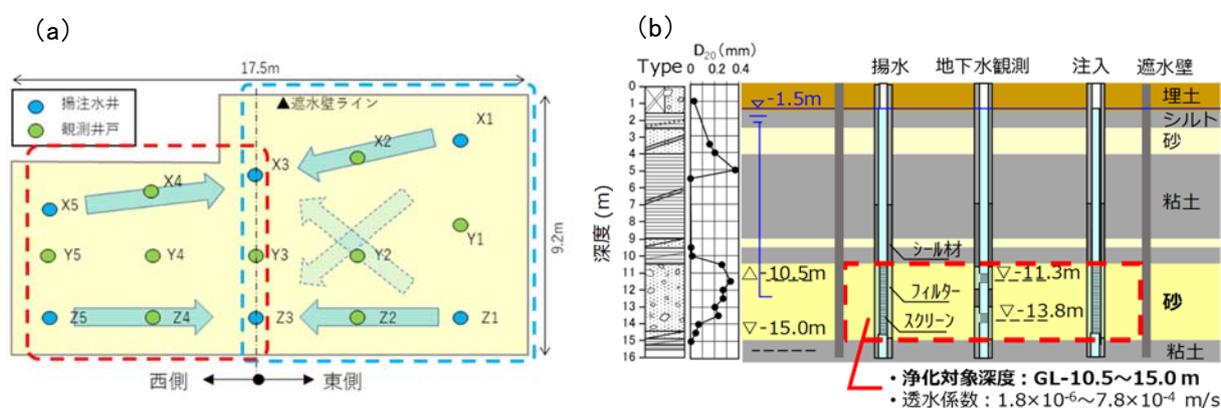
地盤概要 ((a): 平面図、(b): 断面図)
